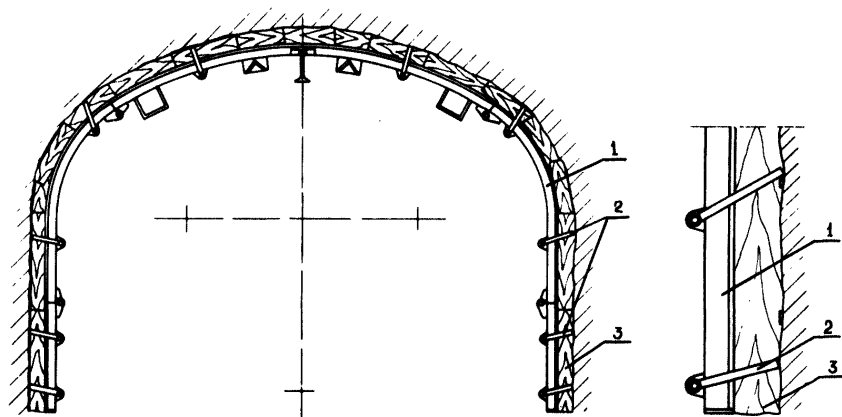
а. Схема изоляции торцевой опалубки путем забивки плах за кронштейны опалубки:
